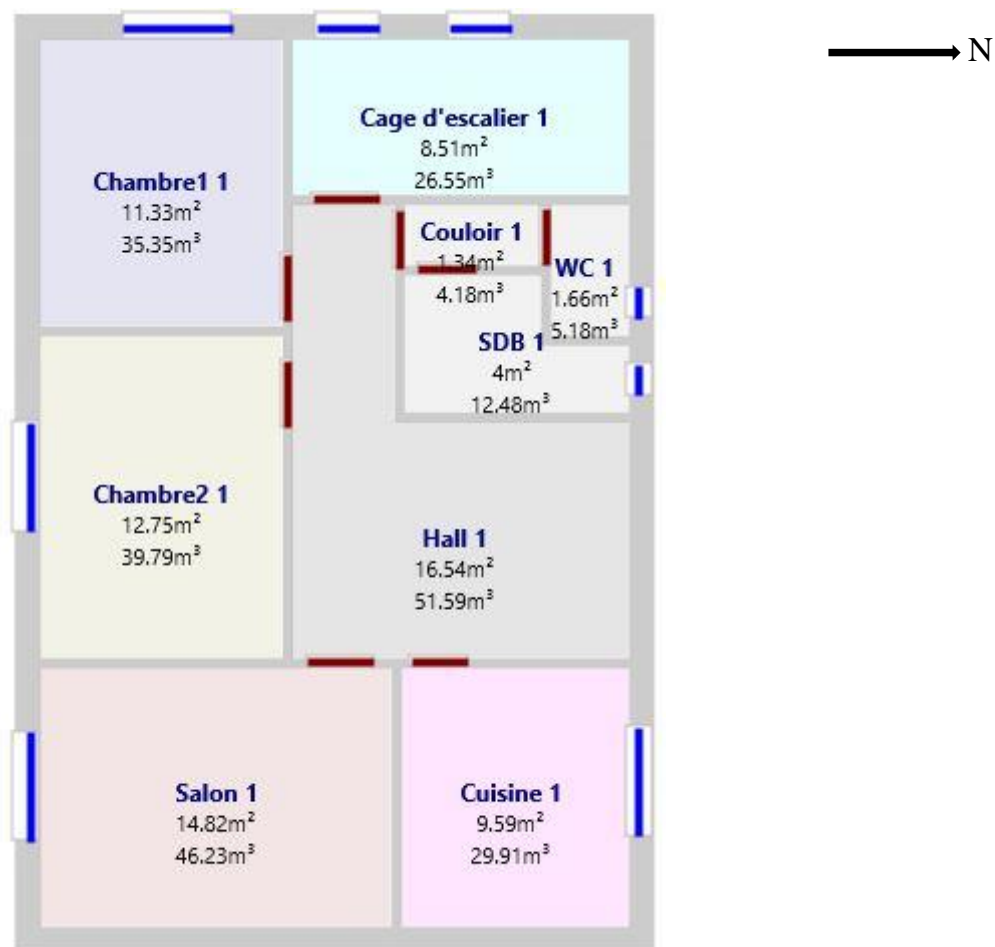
15: plan 1 et 2 étage sous Modeler.
